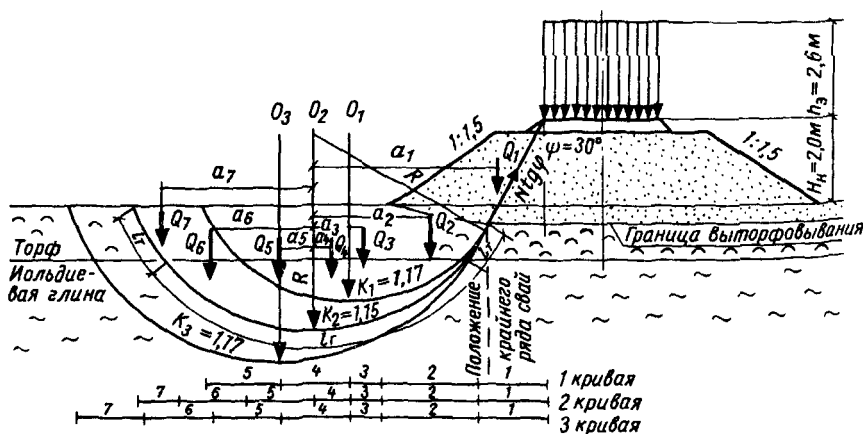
Схема определения расстояния до крайнего ряда свай
